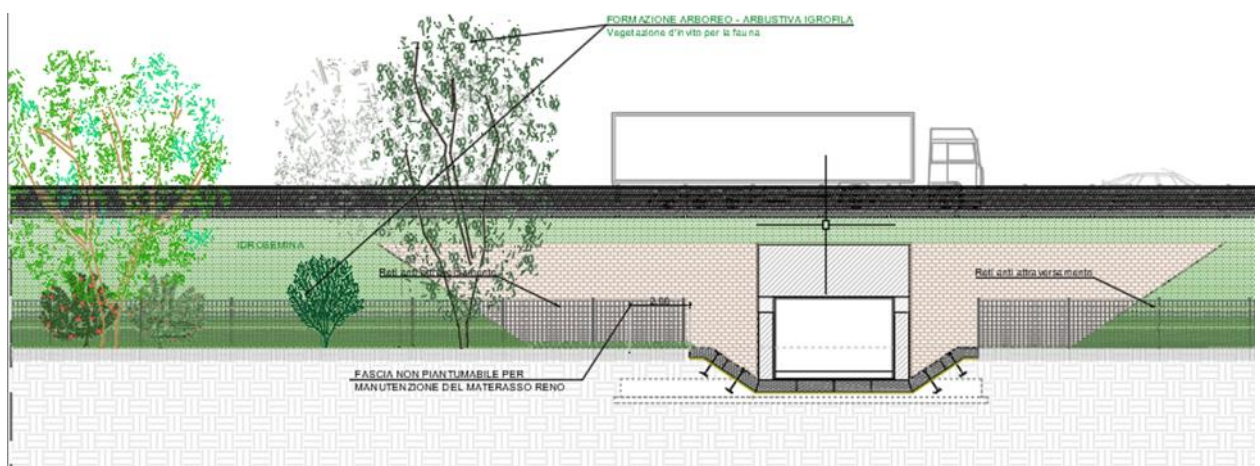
Sezione trasversale stradale dall'elaborato T00IA00AMBSZ10A.
